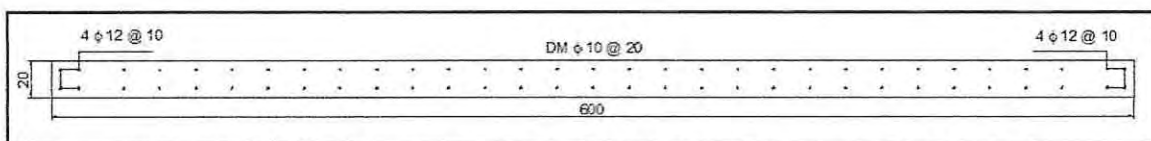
Armadura de flexo-compresión Muro 1, Estructura IV (Aislada)
